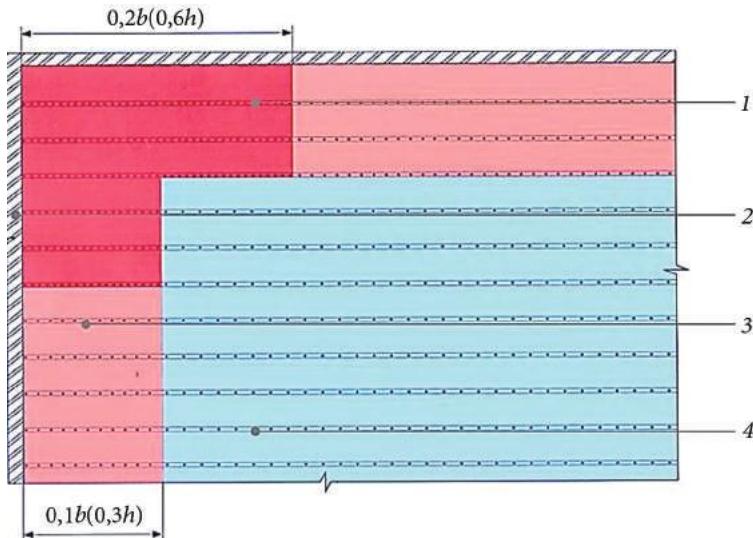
Вариант раскладки и крепления кровельного полотна:
